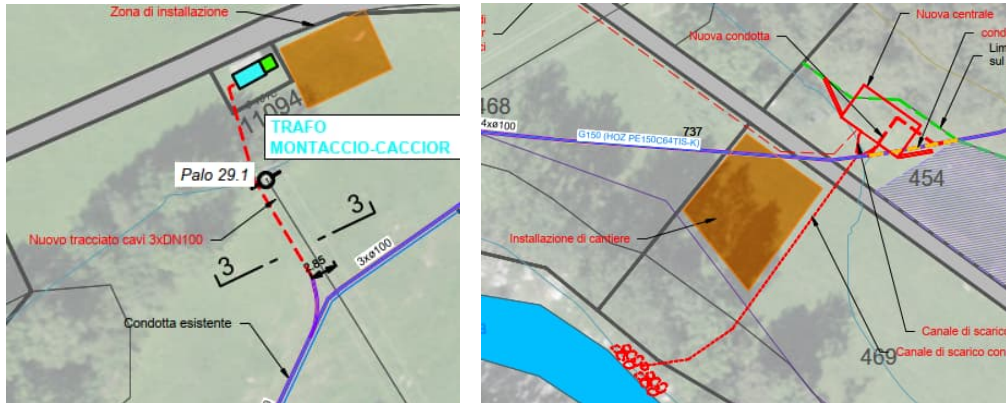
Zone di installazione cantiere a Caccior e Palza
